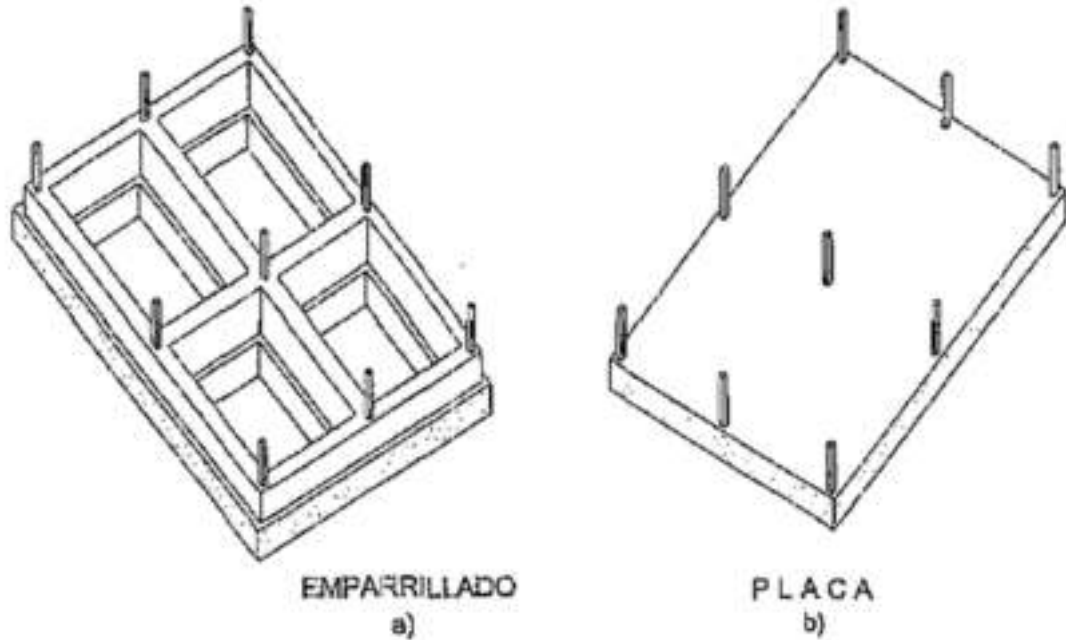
Tipos de Cimentaciones Superficiales (Emparrillados y Losas)
